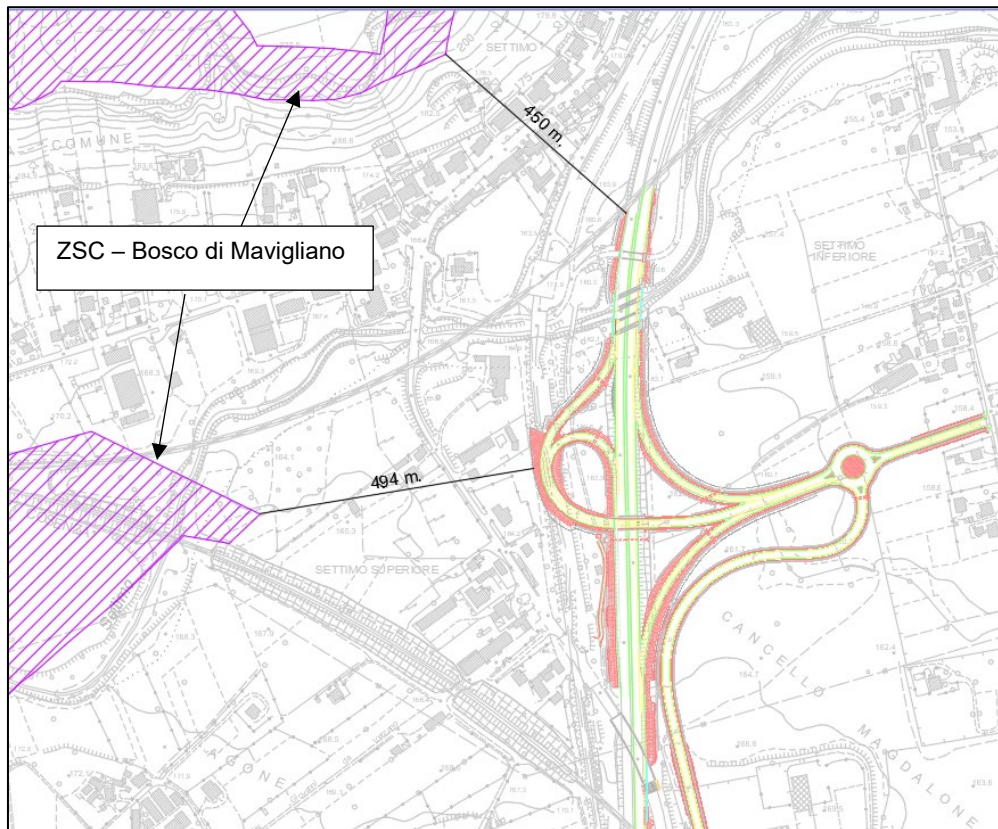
Stralcio planimetrico – Posizione del progetto rispetto alla ZSC
